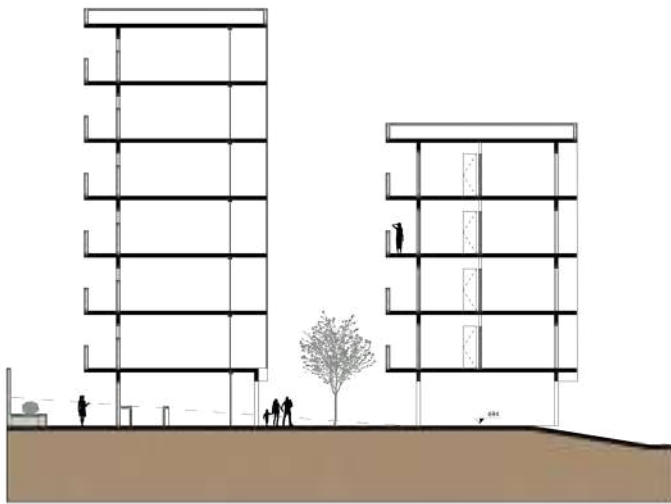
[Elevação Leste. Autor:Autoria do grupo].
